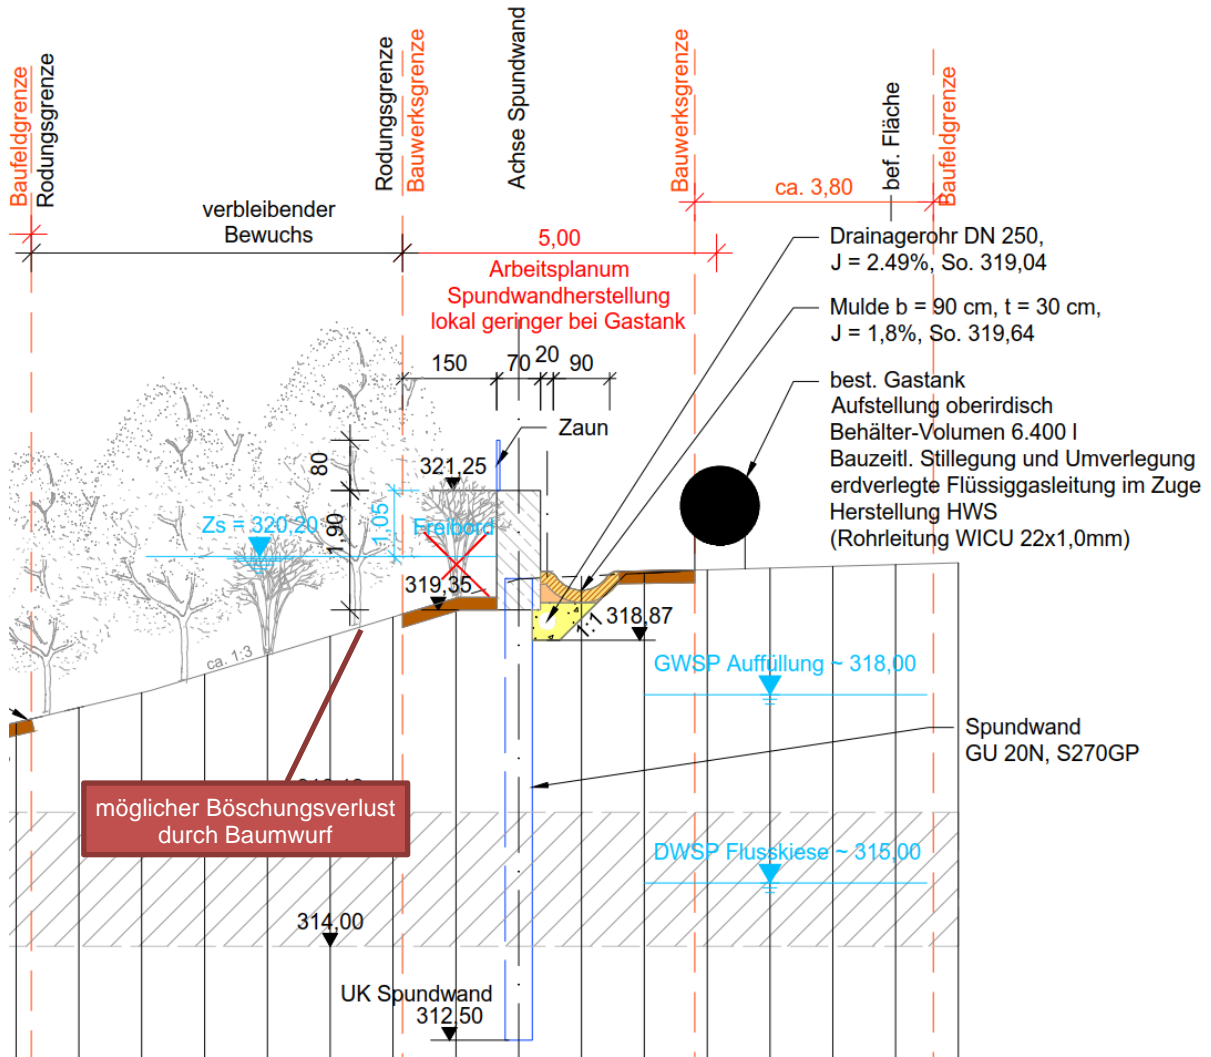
DA 4, Schnitt E-E (aus Plan 04-07-04)
